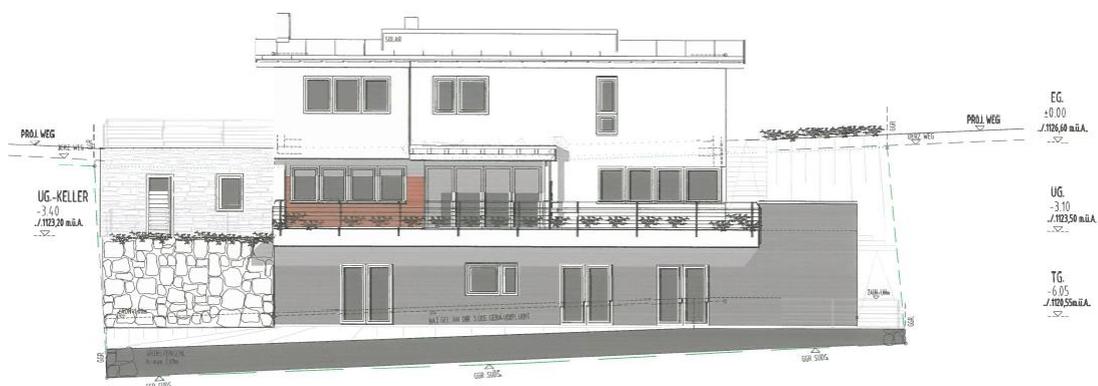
Südansicht – Wohngebäude auf der Gp. 6142 laut Einreichplan des Planungsbüros R&S Planbau (ohne Maßstab)
